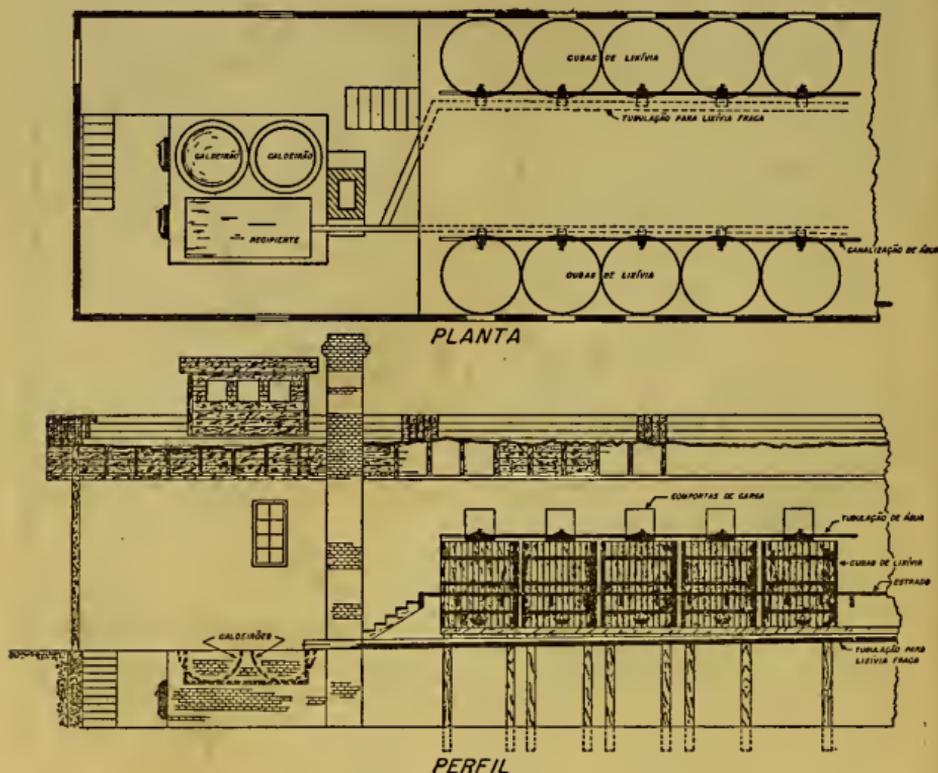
e 2 - PLANTA E PERFIL DE UMA INSTALAÇÃO PARA APROVEITAMENTO DE CINZA DE MADEIRA
